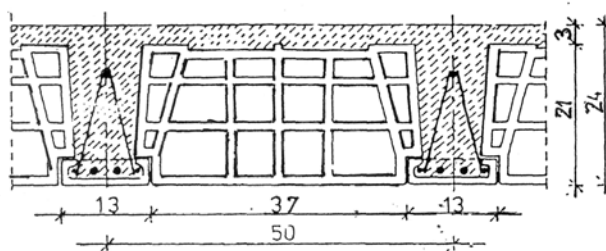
Strop typu Fert: 1 – belka prefabrykowana, 2 – pustak ceramiczny, 3 – beton monolityczny [1, s. 70]
